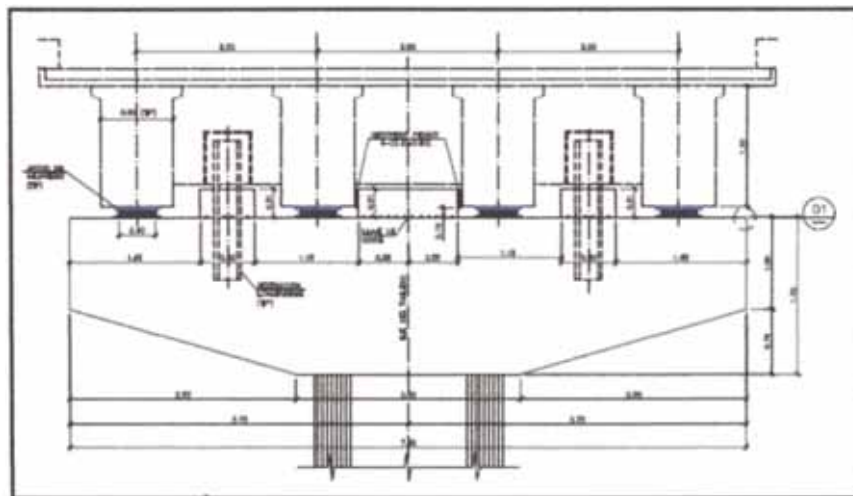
Sección transversal típica de la Viga Cabezal
